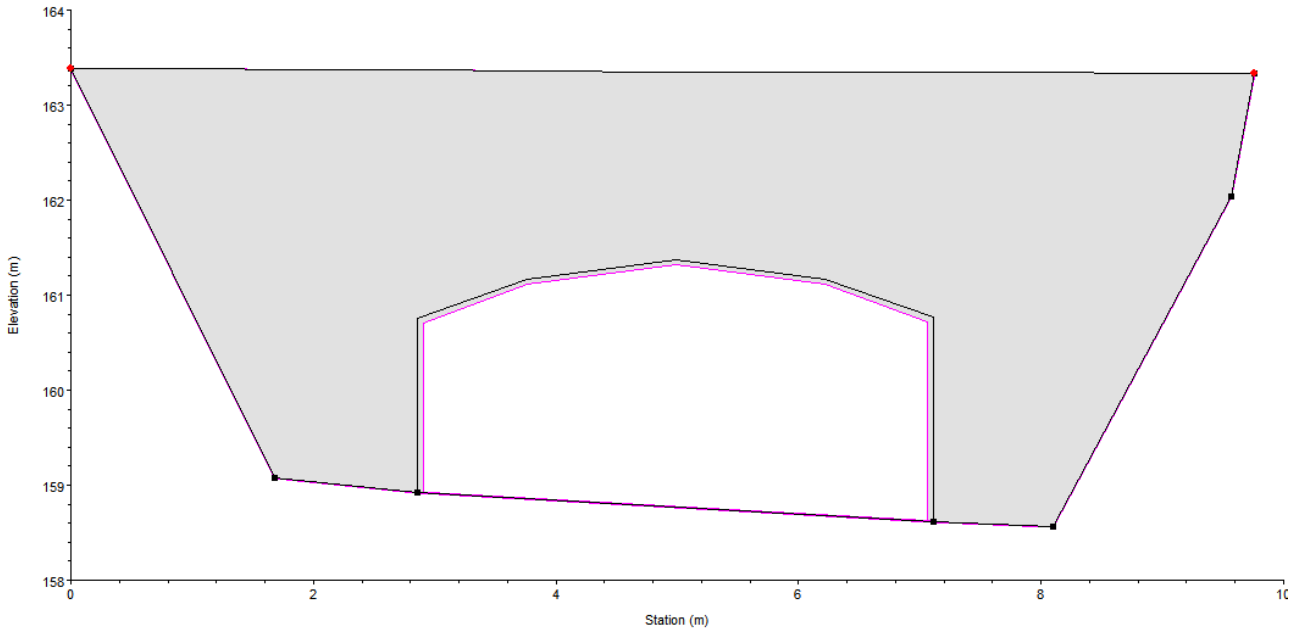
SEZIONE DI MONTE DEL PONTE - STATO SOVRAPPOSTO
